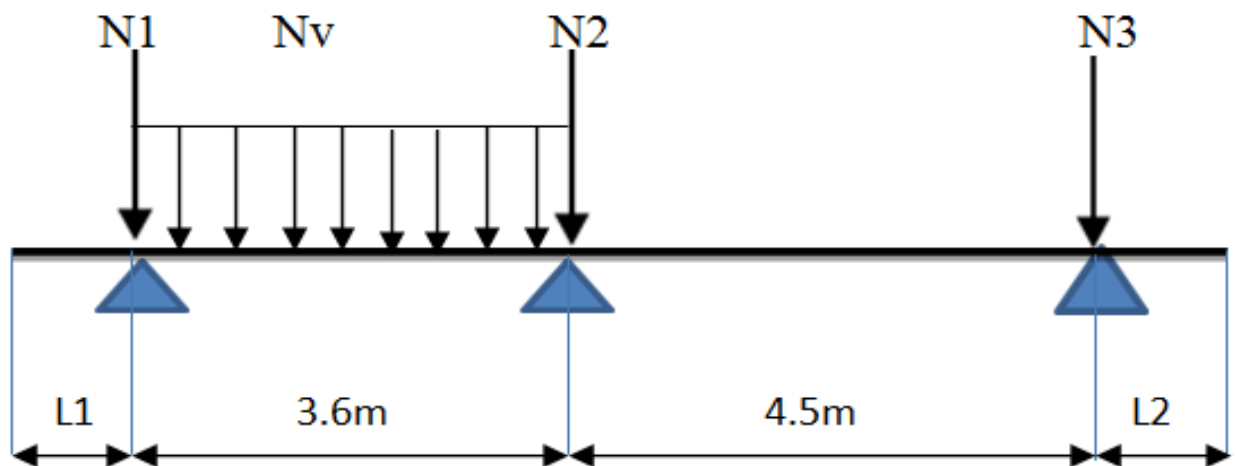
schéma d' une Semelle continue sous trois poteaux et voile.
